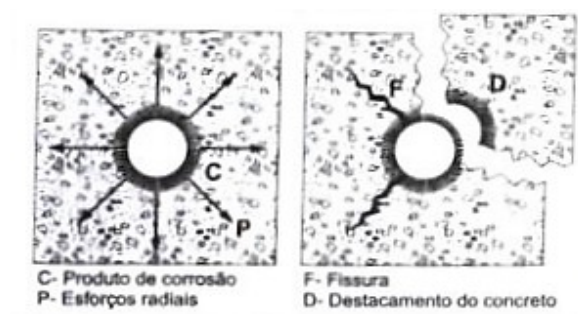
Esforços produzidos que levam à fissuração e destacamento do concreto, devidos à corrosão de armaduras.
